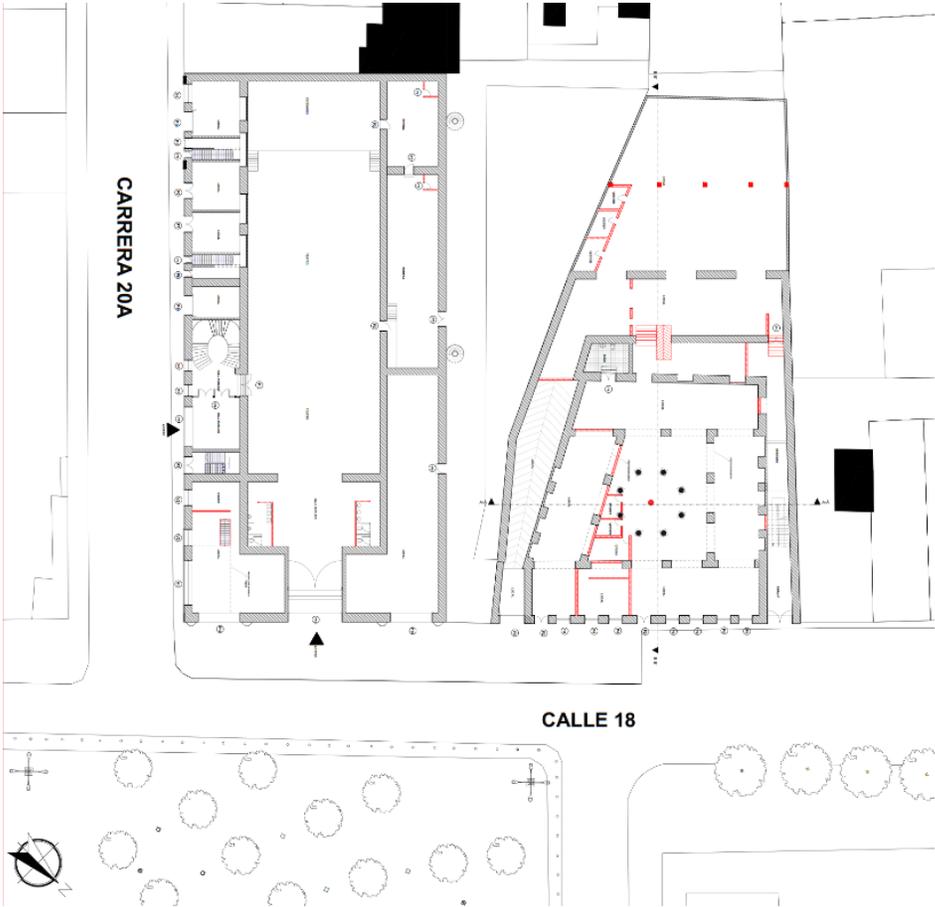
Tercera planta Teatro Alcázar y Casona original realizadas.
